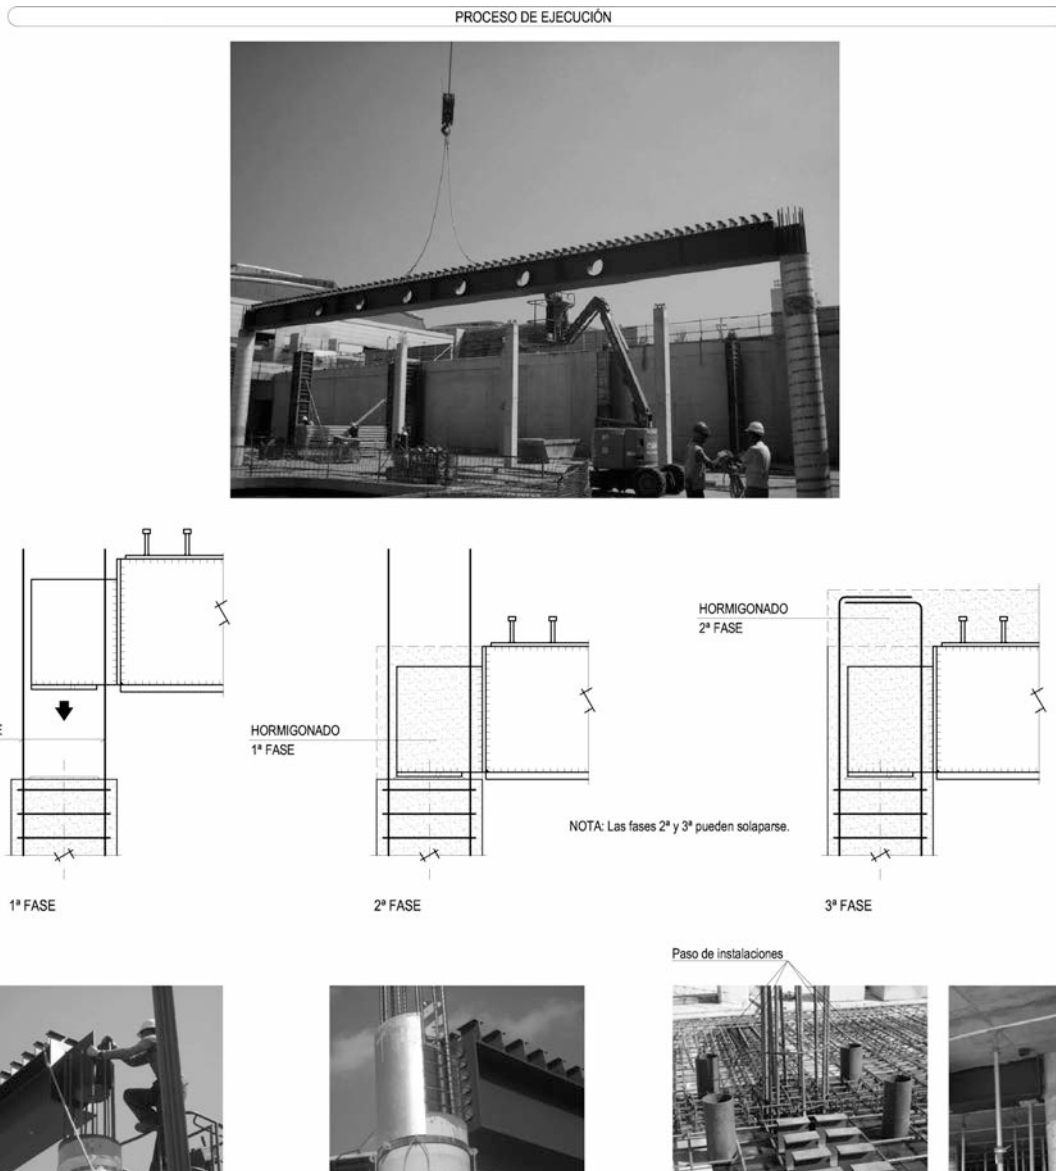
Detalle de apoyo de la parte metálica de vigas mixtas en soportes de hormigón sin equipo de soldadores en obra
